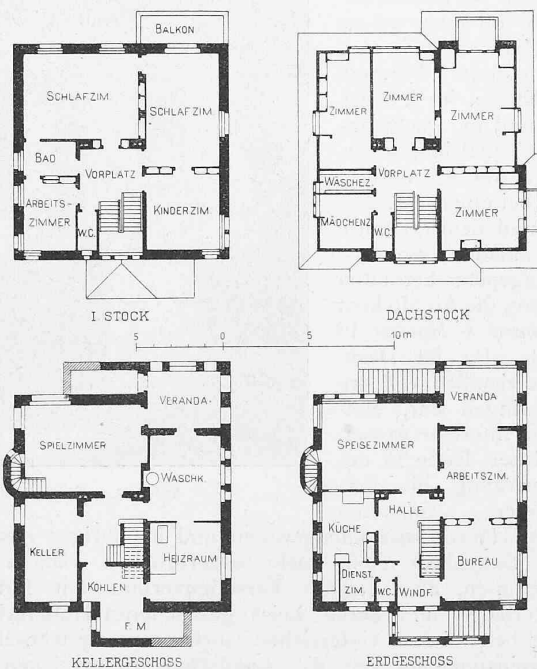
Grundrisse der Villa «im Oberland» in Zürich V. — 1:400.
